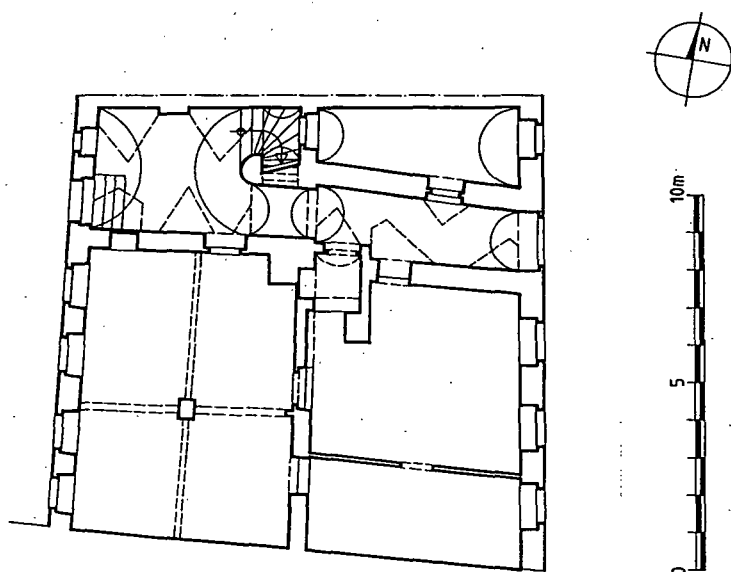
Schiferplatz 8 – Grundriss Erdgeschoss (1:200).
